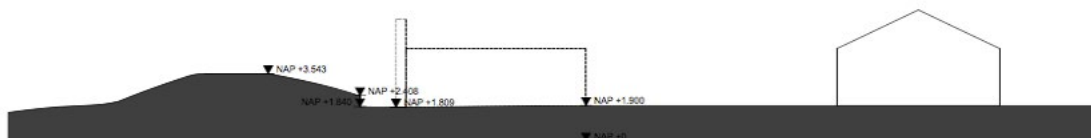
Tekening bouwplan met beschermingszone legger
